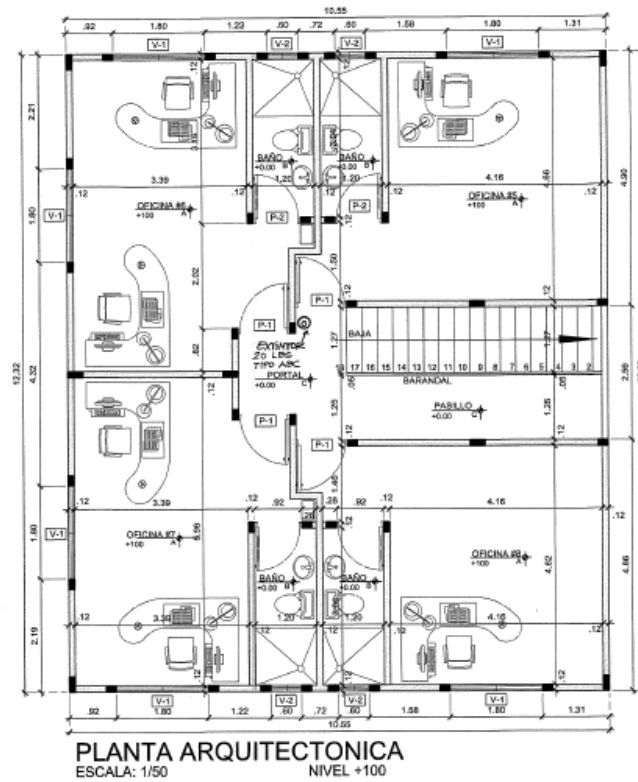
Planta arquitectónica del proyecto nivel +100. Fuente. Plano del proyecto
